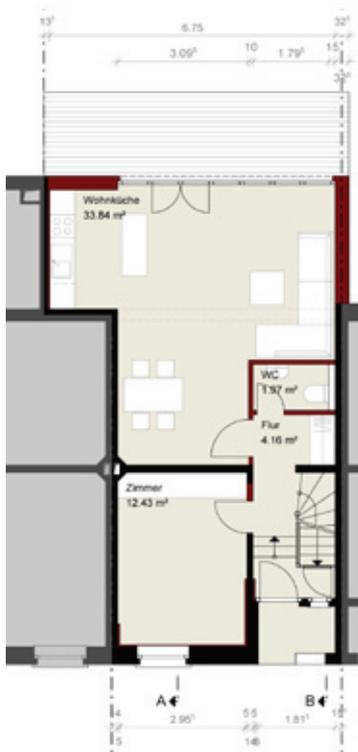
Grundriss Erdgeschoss Einzelhaus Variante 2.1
